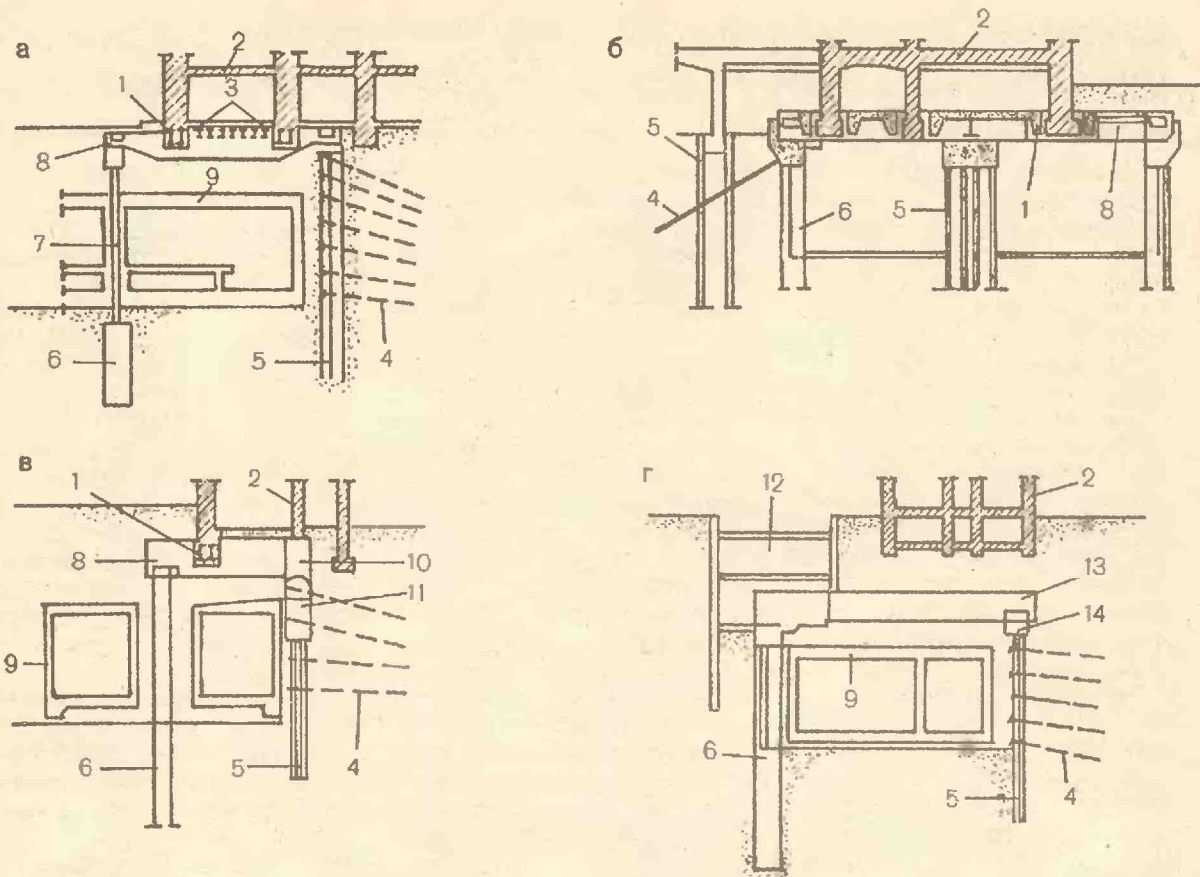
Схемы опорно-ограждающих конструкций при строительстве подземных сооружений котлованным способом (а—г): 1 — раицбалки; 2 — здание; 3 — подхваты; 4 — грунтовые анкеры; 5 — стены из микросвай; 6 — буронабивные сваи; 7 — стальные колонны; 8 — преднапряженные балки; 9 — подземное сооружение; 10 — продольная балка; 11 — штольни; 12 — «забойный» котлован; 13 — экран из труб; 14 — ростверк.
